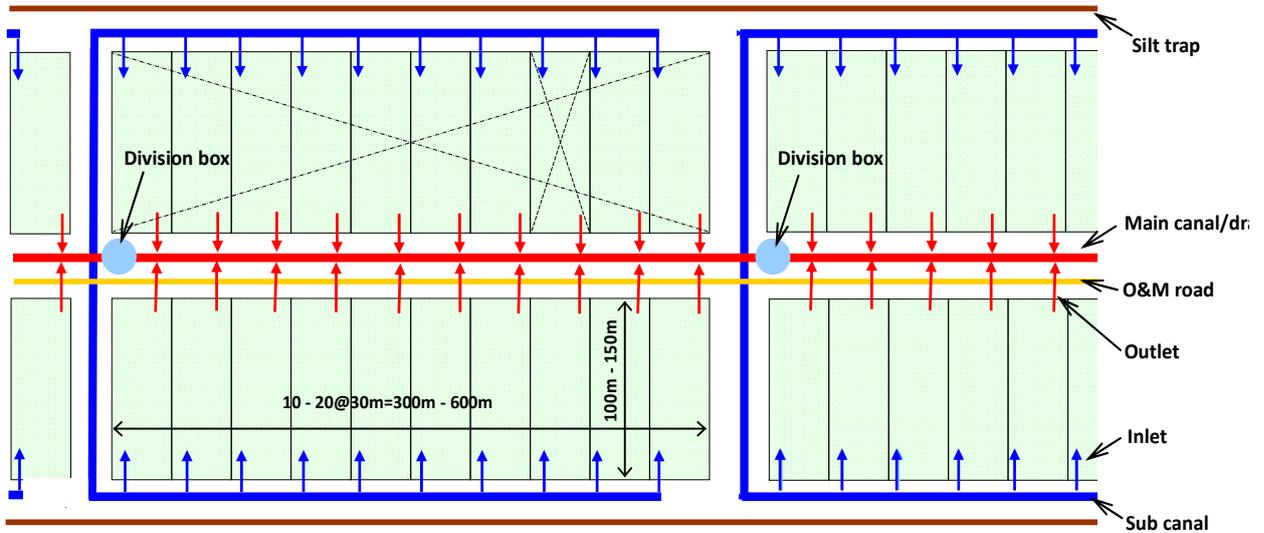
Plan type d'aménagement de la rizière existante
